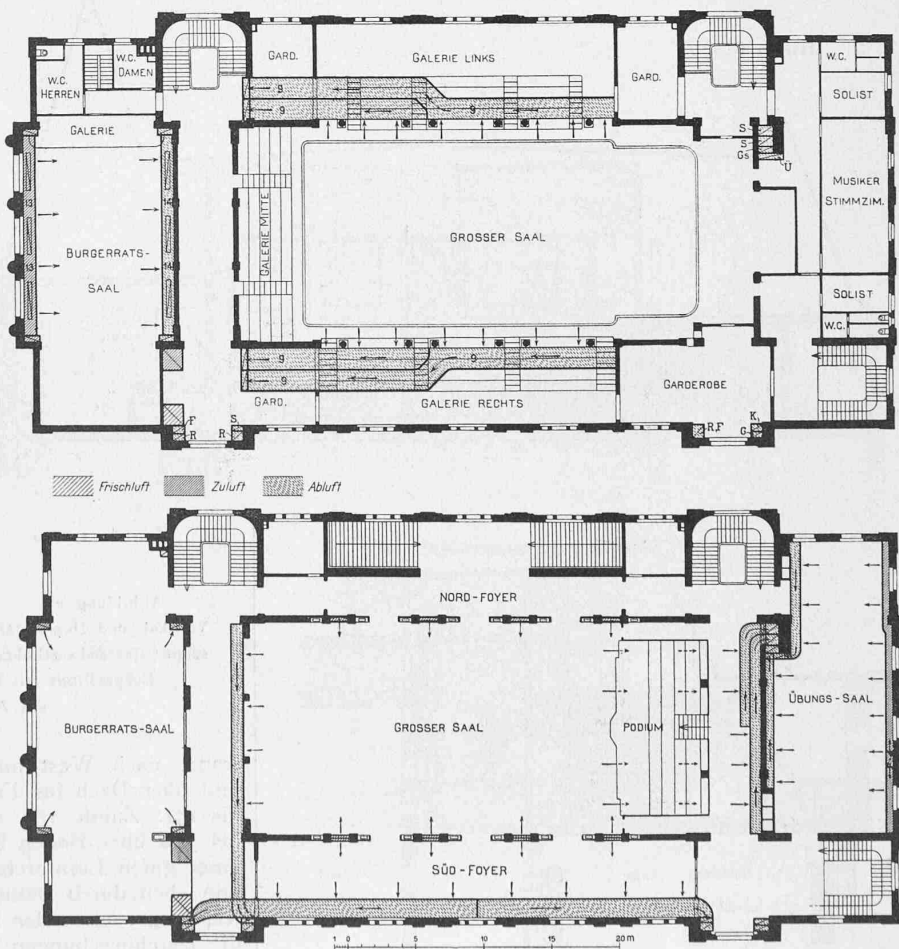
u. 17. Grundrisse vom I. Stock und vom Galeriegeschoss. — Masstab 1:500.
